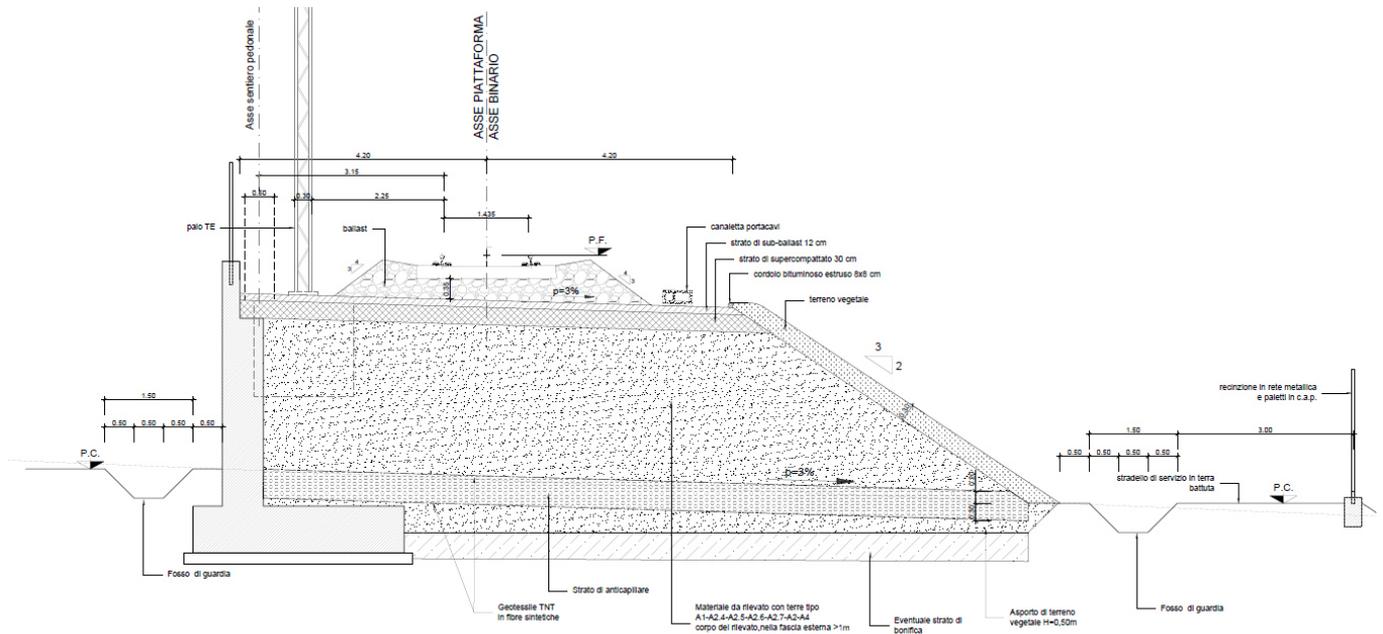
Sezione tipo con muri su un lato- asta L=750m
